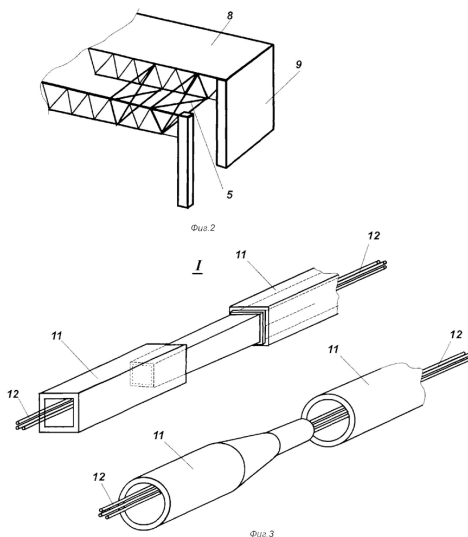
Фиг. 2 – соединение ферм покрытия между собой поперечной несущей конструкцией; фиг. 3 – узел I на рис. 1 – подвижный узел нижнего пояса фермы, выполненный в виде прямоугольного или круглого сечения [4], где: 5 – поперечная несущая конструкция; 8 – крыша здания; 9 – наружные стены здания; 11 – подвижные элементы нижнего пояса; 12 – несущие канаты.
